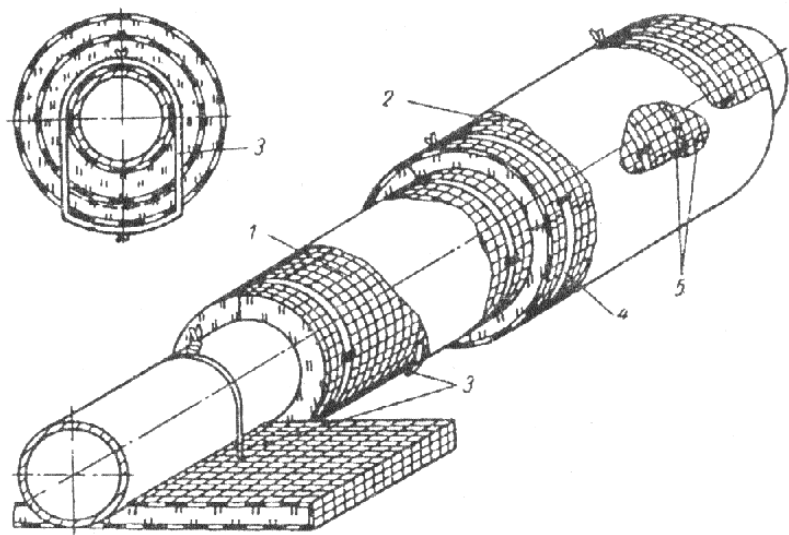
Тепловая изоляция трубопроводов минераловатными матами на подвесках
